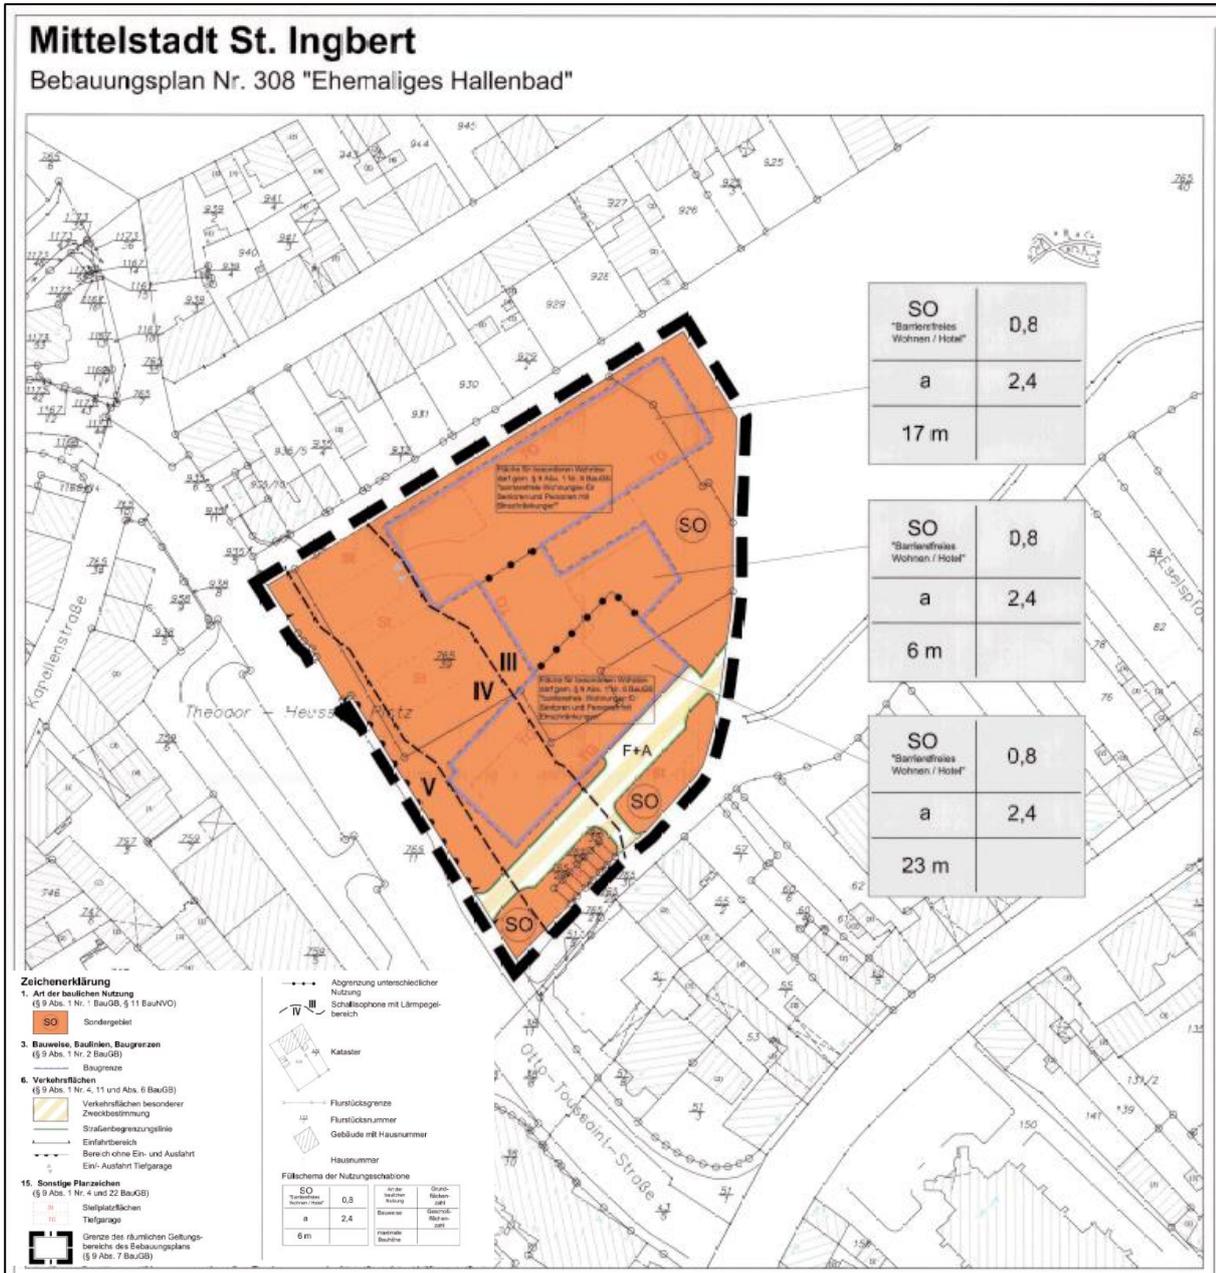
Auszug aus dem Bebauungsplan "Ehemaliges Hallenbad" der Stadt St. Ingbert (FIRU mbH im Auftrag der Stadt St. Ingbert)
